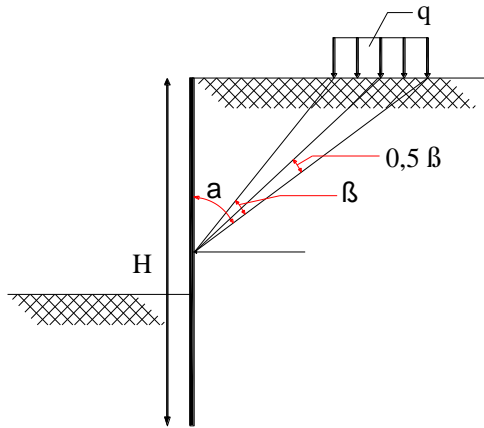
6 Tekanan Tanah Akibat Beban Garis (*Design Of Sheet Pile Walls*)
